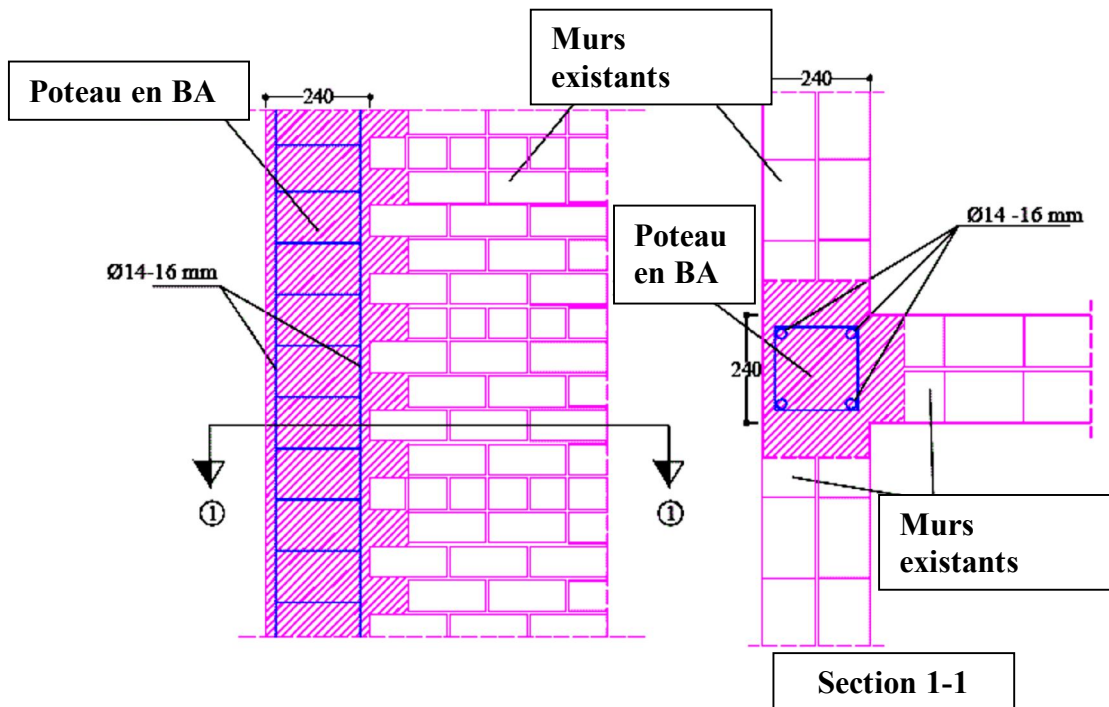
Réalisation d'un nouveau poteau de renforcement en béton armé
